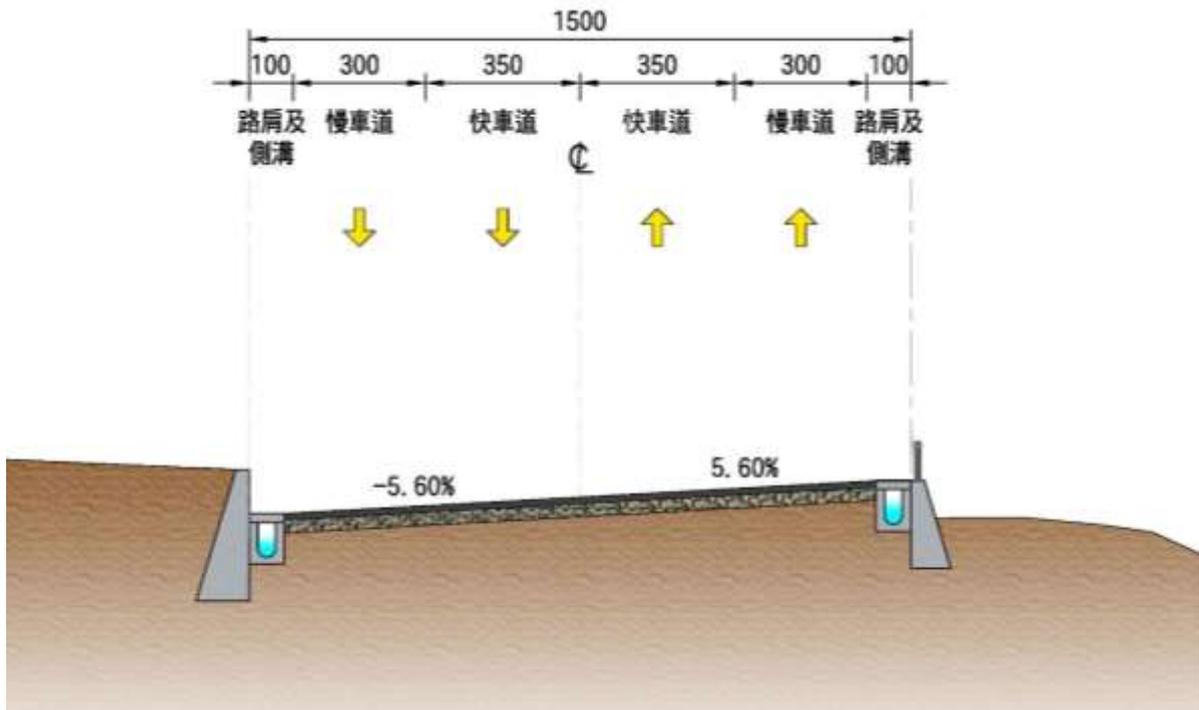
本計畫道路拓寬工程之道路施工段標準斷面示意圖
